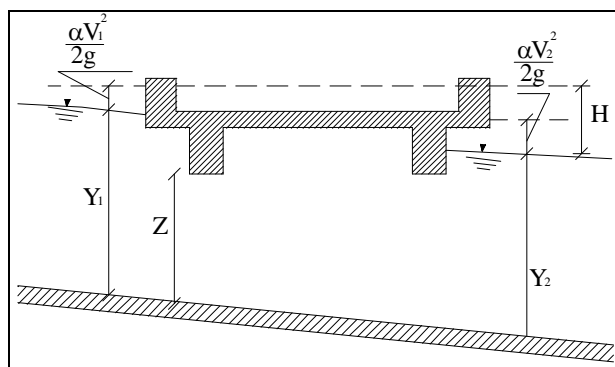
Sezione schematica di un ponte – Schema di calcolo
